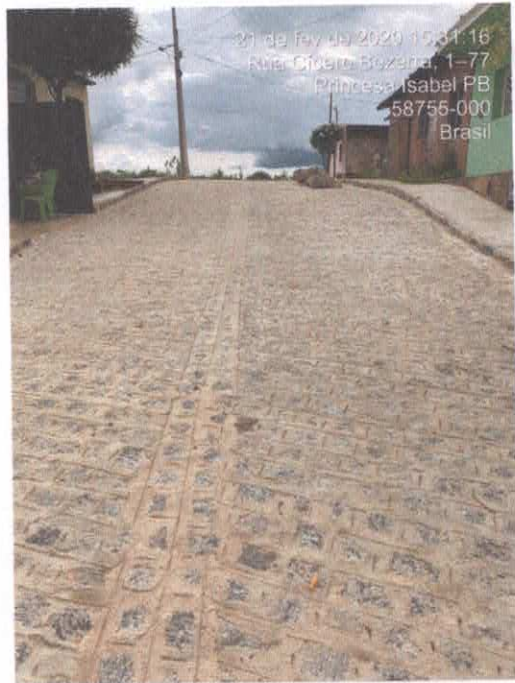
Complemento da pavimentação da rua Professor Antônio Eugênio
